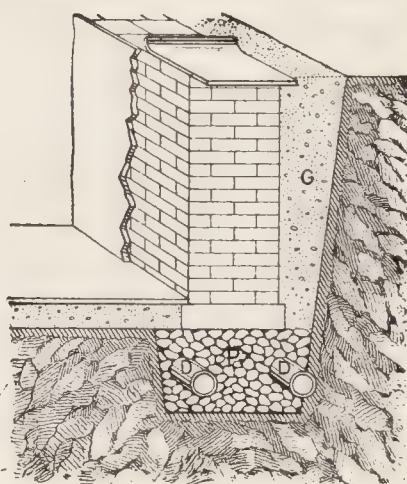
Fondation avec drainage spécial (d'après Emmerich). — D, drains en poterie. — G, gravier. — P, pierrailles.
